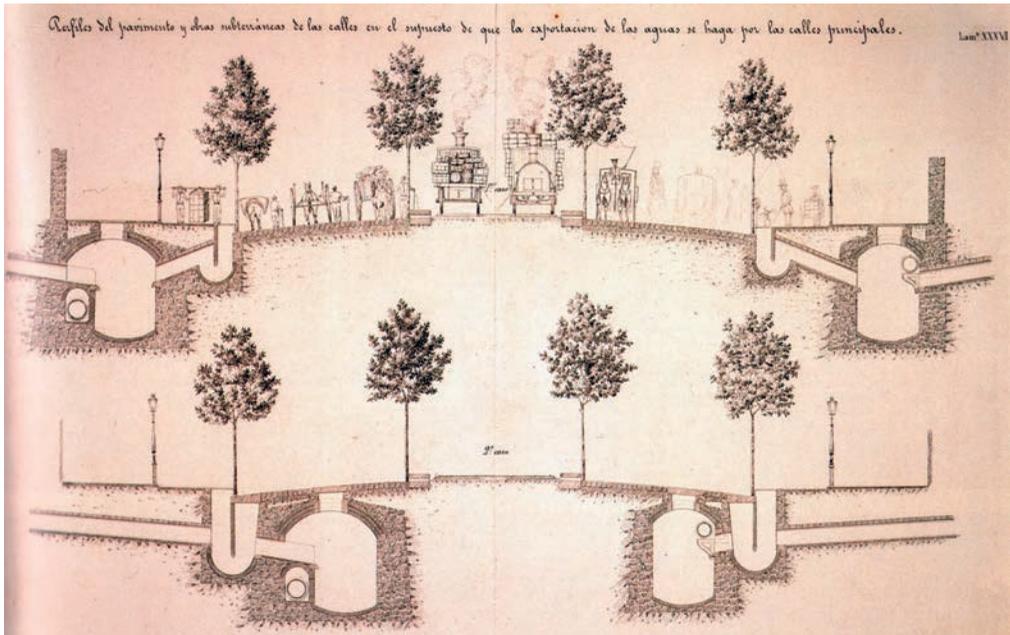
Plan de l'Eixample de Barcelone. Section de rue du projet « Plan Cerdà ». 1859.
